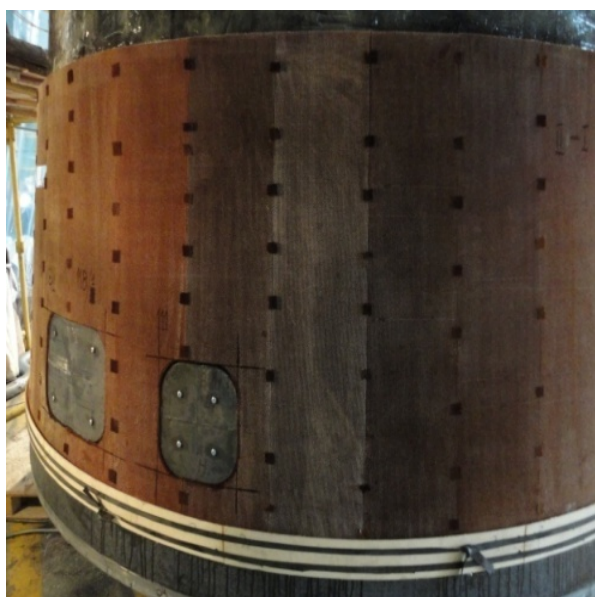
Установка на обшивку СЗ и вкладышей из пенопласта
